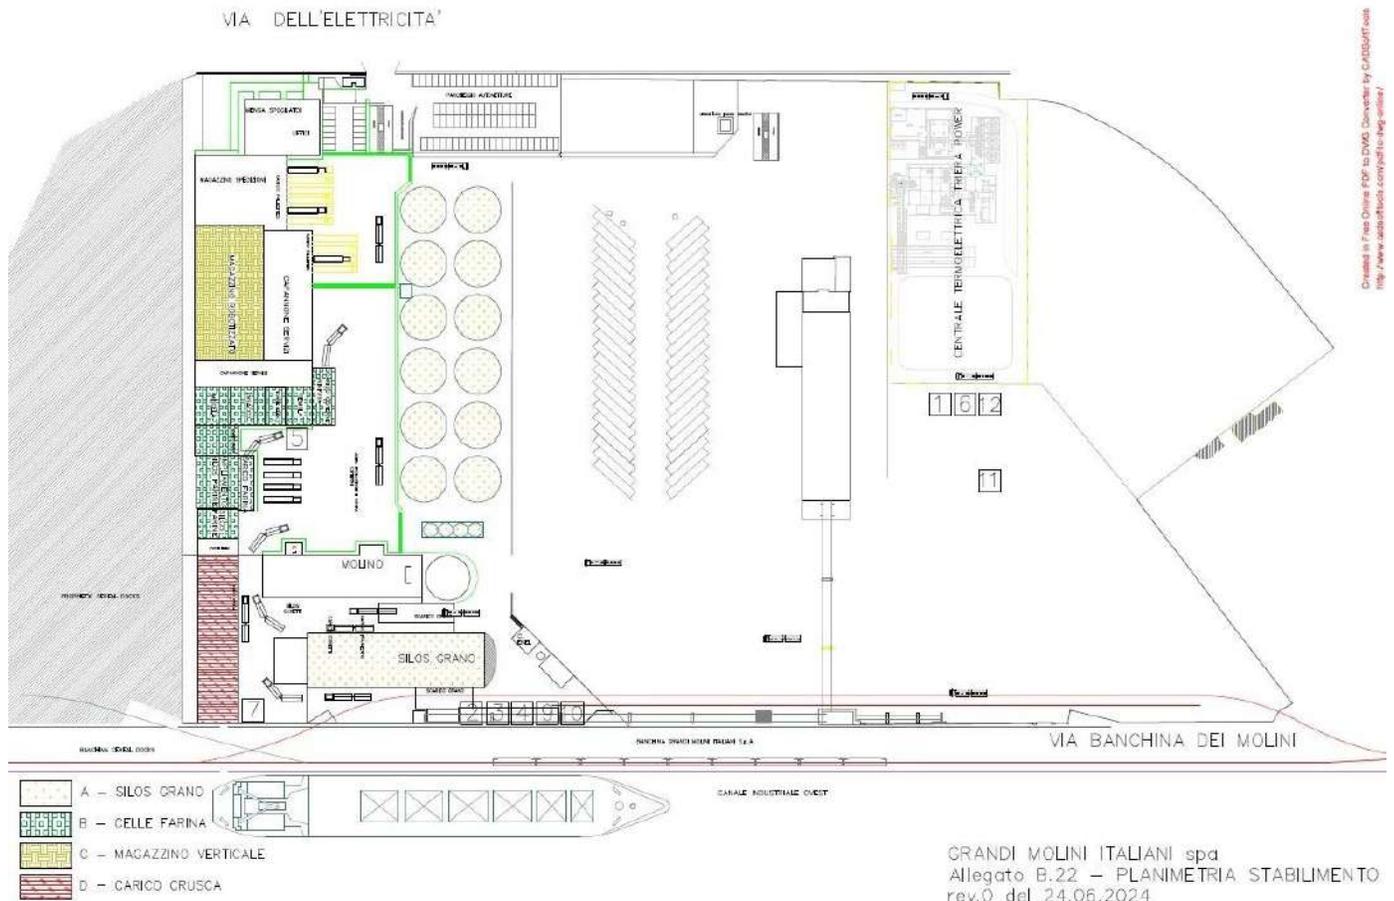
Estratto planimetria B22 – Stoccaggi attuali
